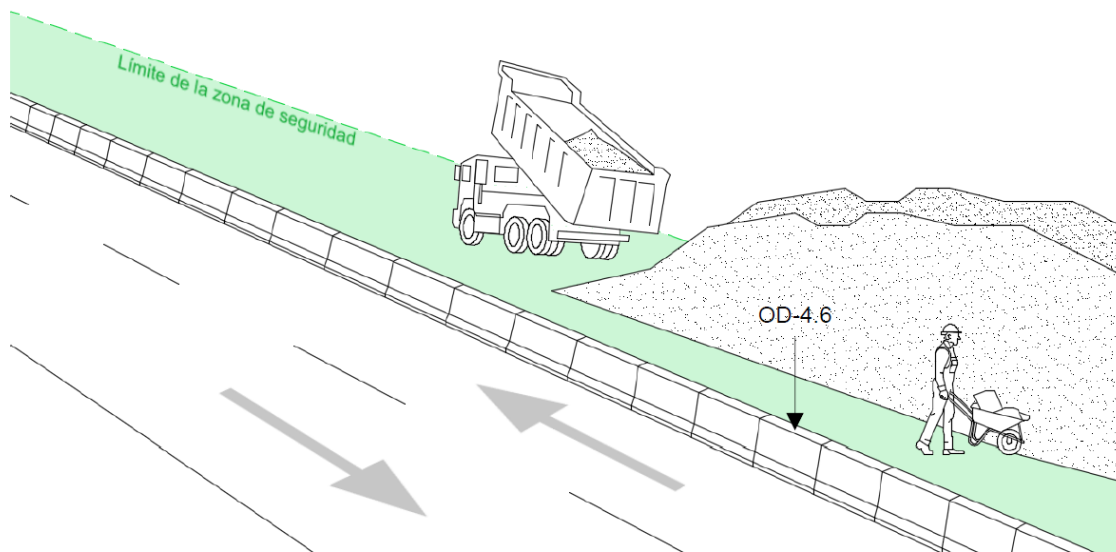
Barrera en zona de obra (OD-4.6)
